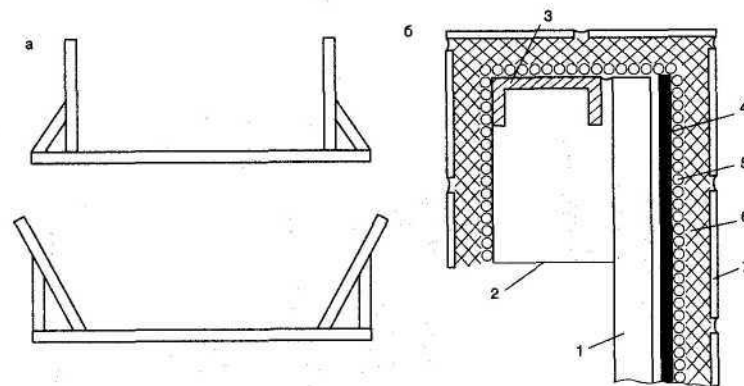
Конструктивные элементы бассейна со стальным корпусом и облицовкой керамической плиткой:
